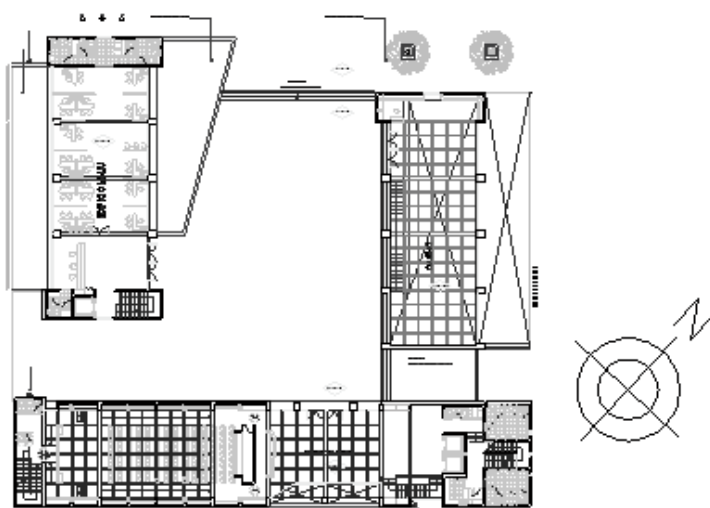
Planta Piso 1 – Acceso – Nivel 0,00
